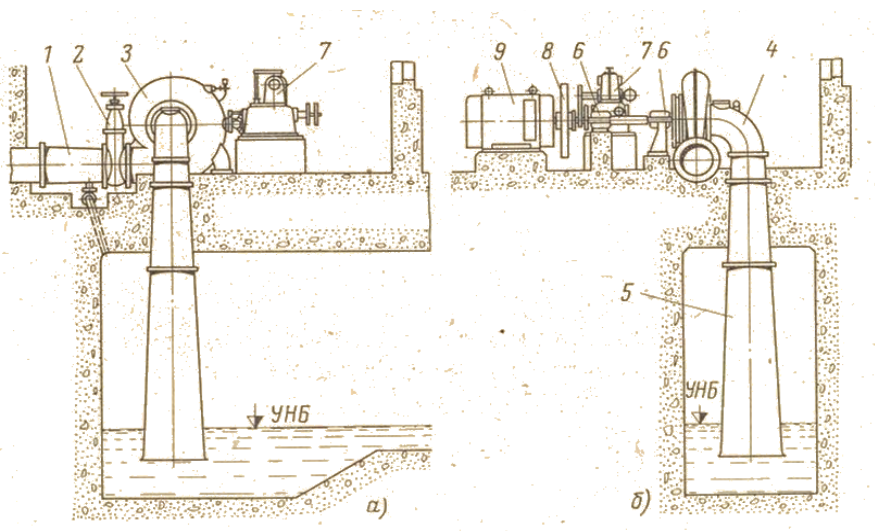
Стандартный гидроагрегат фирмы «Фойт»: а) вид со стороны отсасывающей трубы; б) боковой вид.
